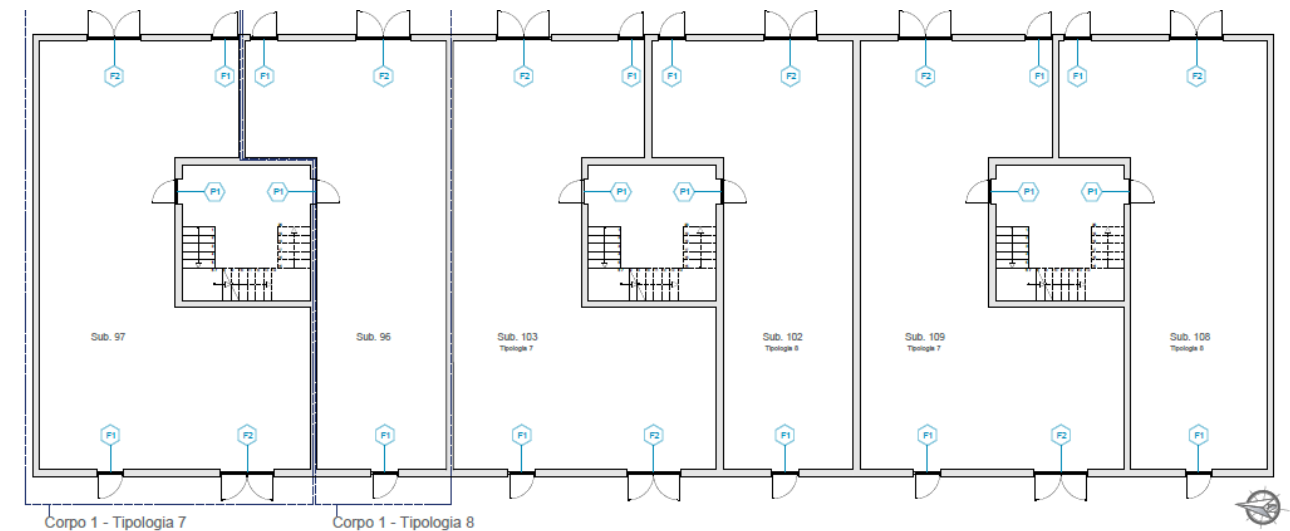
Pianta Stato di fatto, piano terzo- Corpo 1
